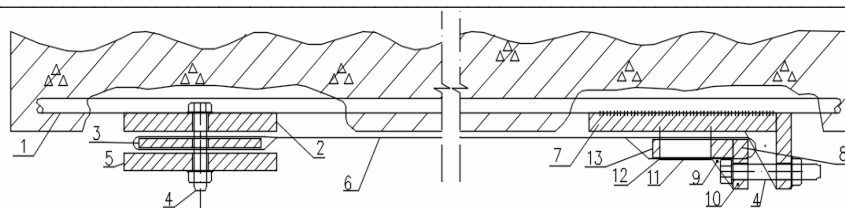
Усиление балки композитным материалом: 1 — пакет арматуры; 2 — верхняя пластина; 3 — пластина, обернутая ламелью; 4 — высокопрочный болт; 5 — прижимная пластина; 6 — ламель; 7 — неподвижная пластина натяжного анкера; 8 — задняя стенка подвижной части анкера; 9 — ребро жесткости подвижного анкера; 10 — задняя стенка подвижного анкера; 11 — полка уголка № 16; 12 — уголок № 16; 13 — подвижный анкер
